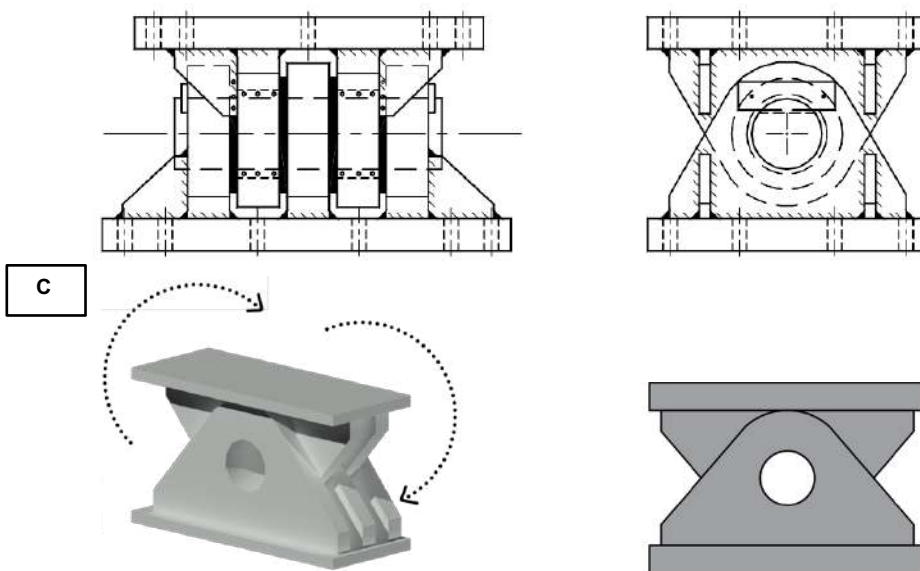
C. Apoio rotulado metálico para cargas reversíveis. Fonte: autoral
